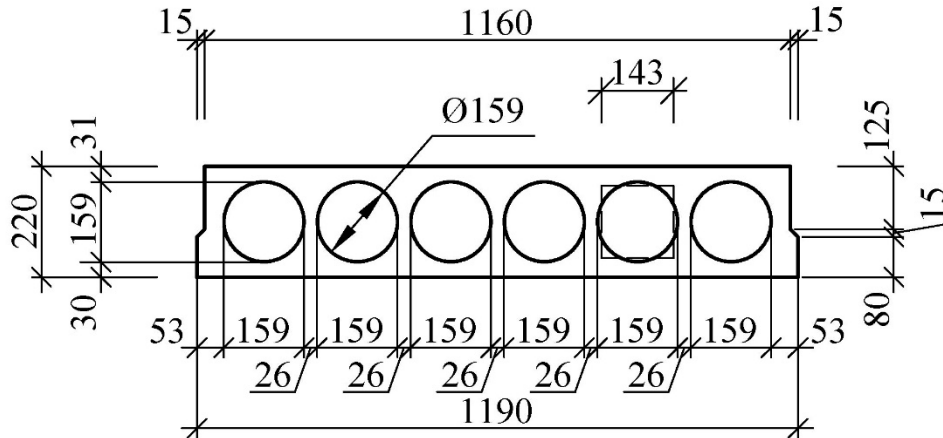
Фразмент поперечного перерізу багатоповерхової плити перекриття
